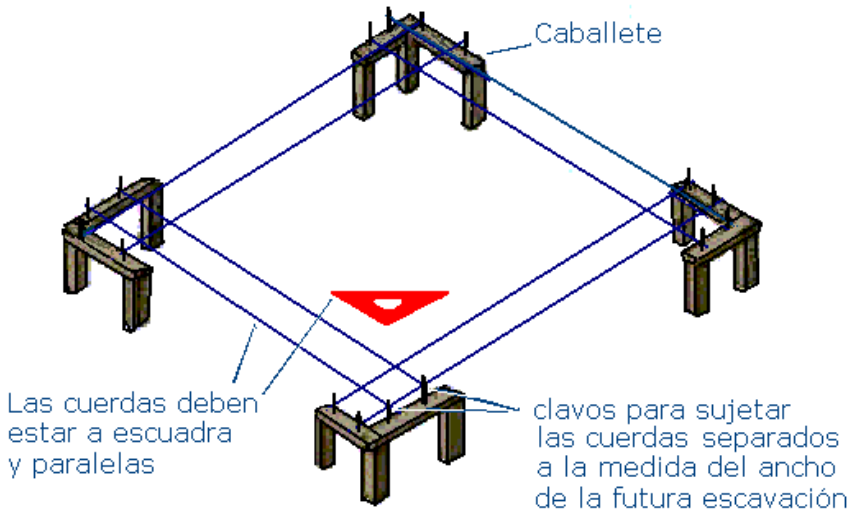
tomada de internet: www.construccionnaturalbariloche.blogspot.comexcavado zanja
